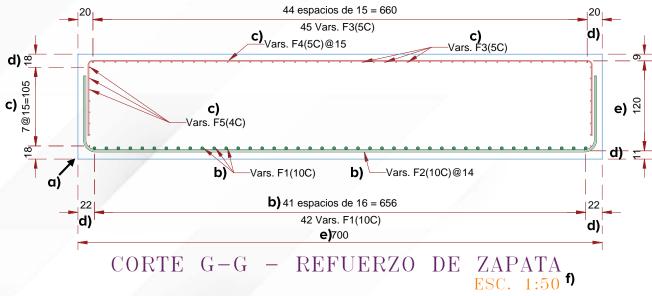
Ejemplo de elevación de refuerzo de la zapata, corte G-G
